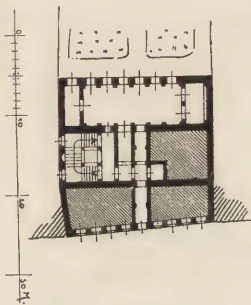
Wohnhaus des Giulio Romano zu Mantua. Grundriss.
